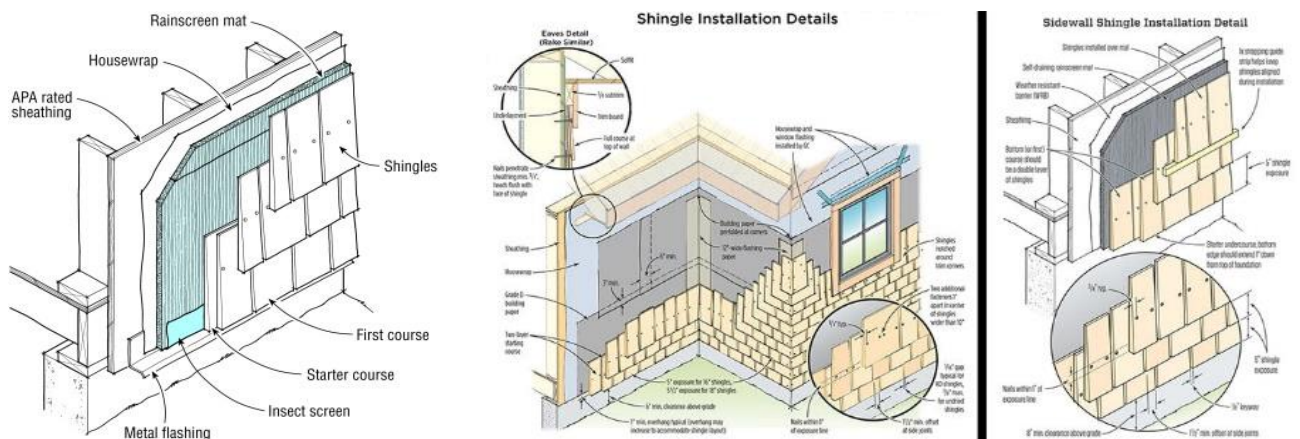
; рис.6.24. Приклад влаштування гонту на вентильованому фасаді [79], [80].
